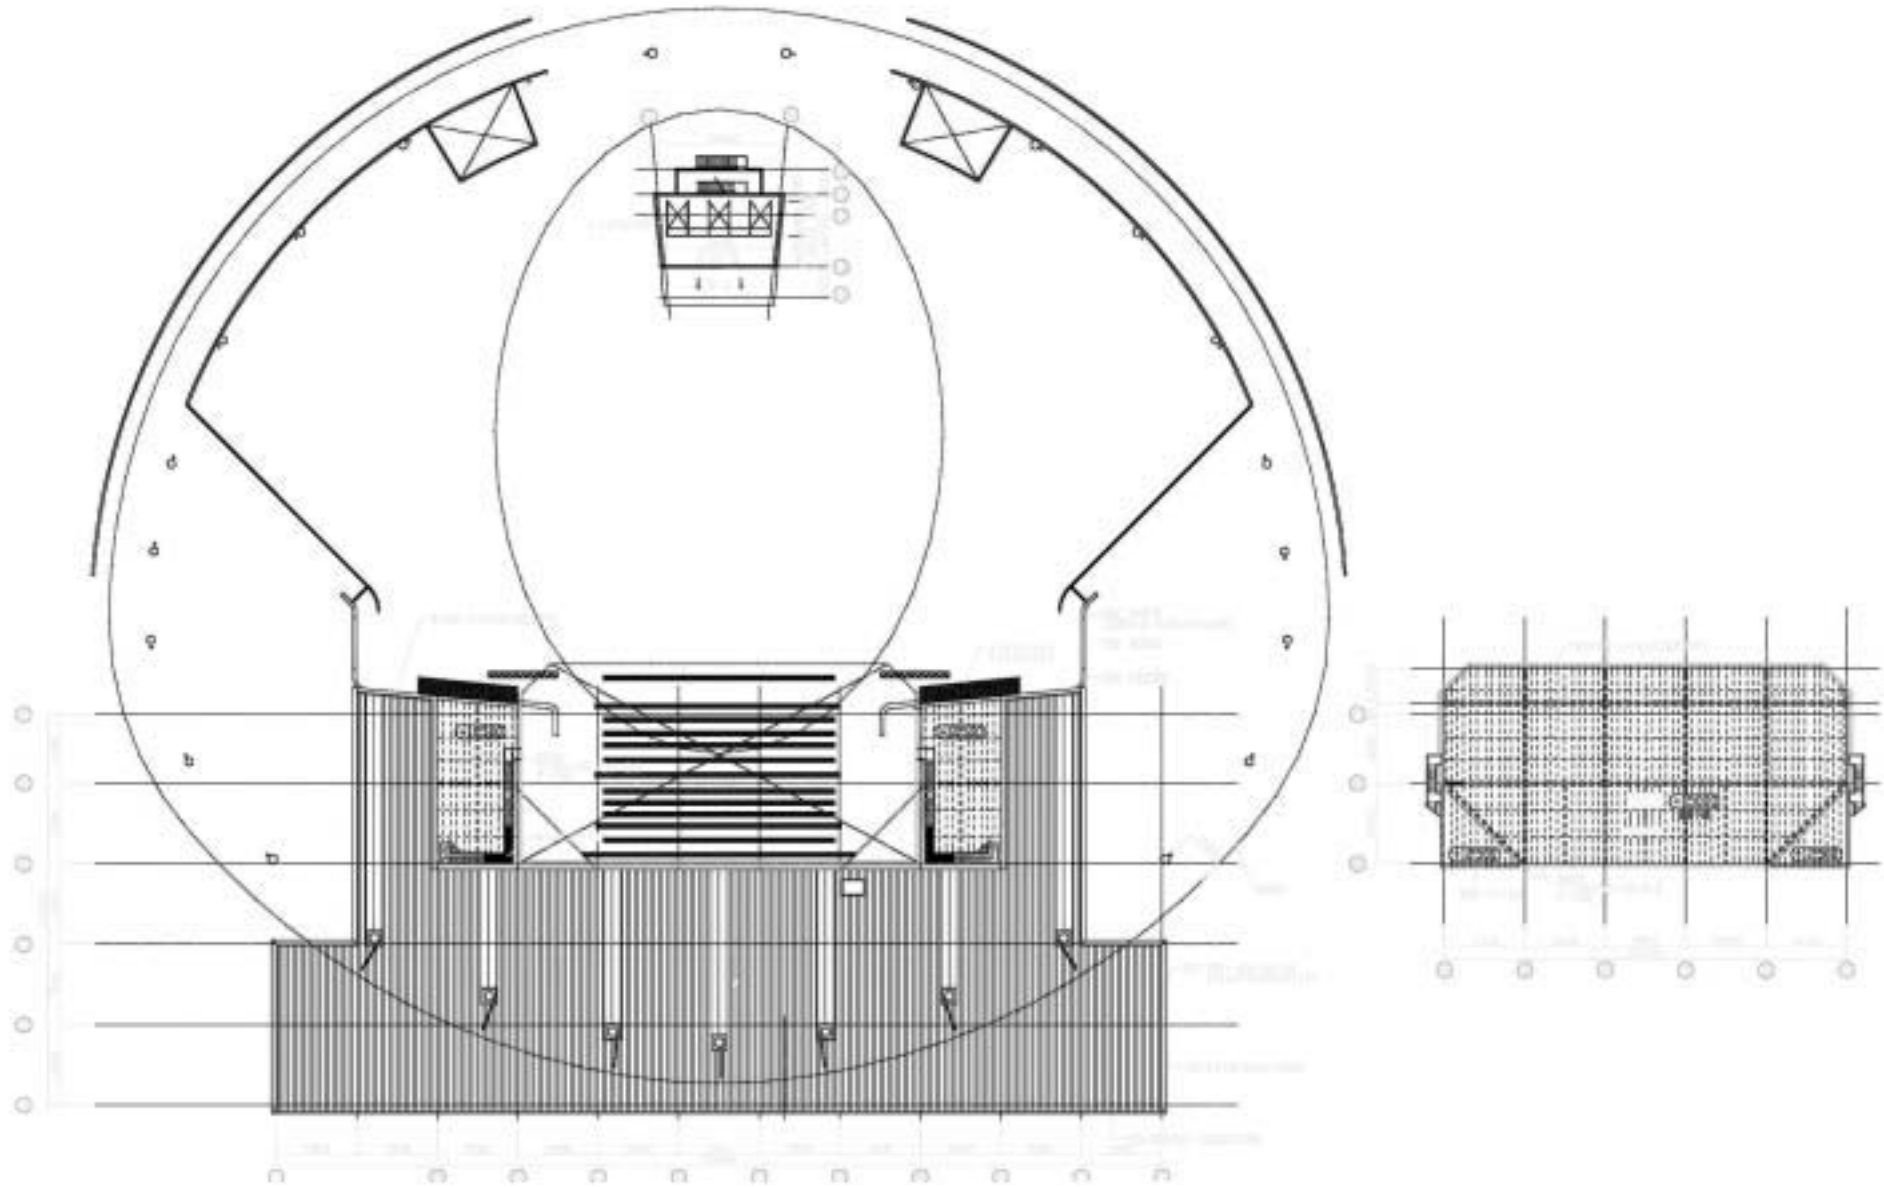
6 (3) 施設構造 (平面図 : 屋根)
